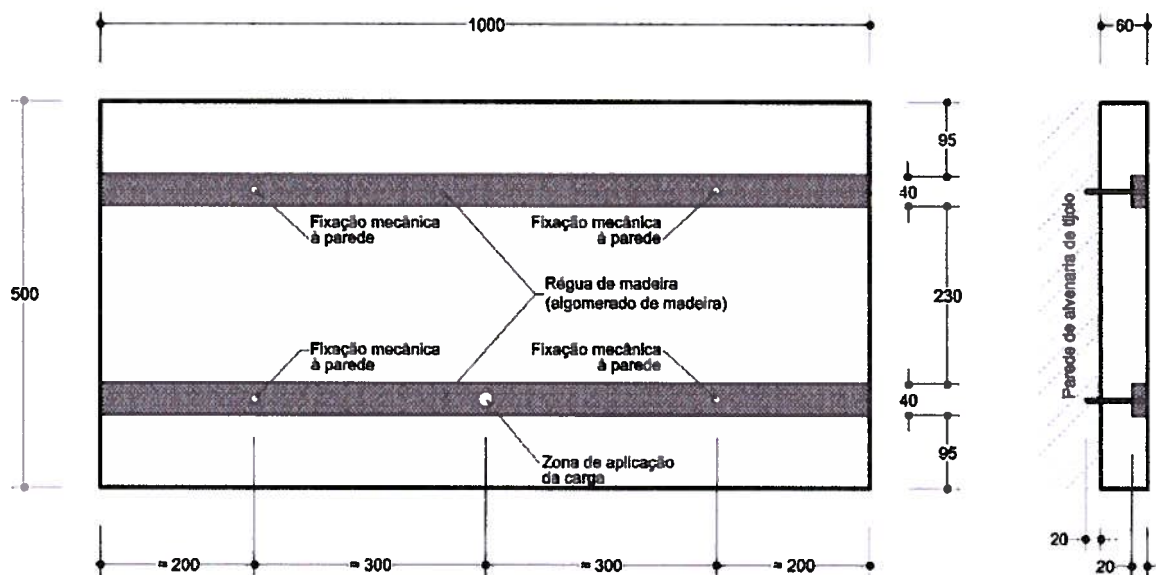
Esquema de fixação do isolamento à parede e das zonas de ensaio (dimensões em mm)
